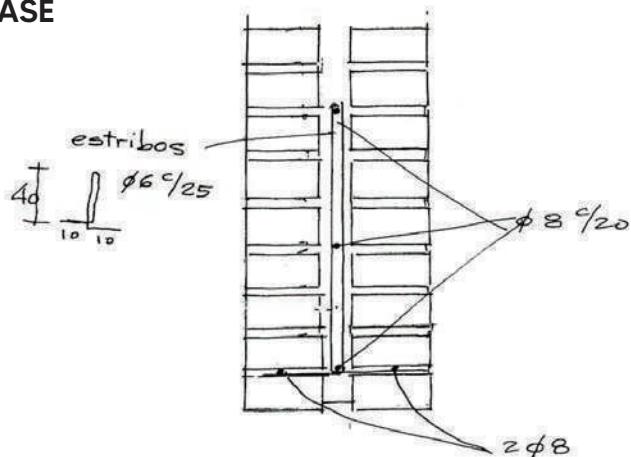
Detalhe da verga do portão em tijolo armado. (*-5).
